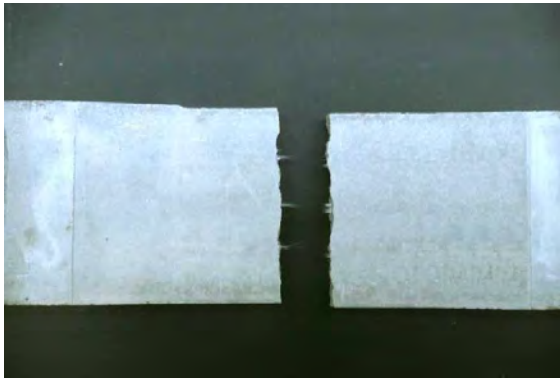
Betonprobekörper nach dem Zugversuch, VET ARG, 360 d, Wasserlagerung, 60 °C
